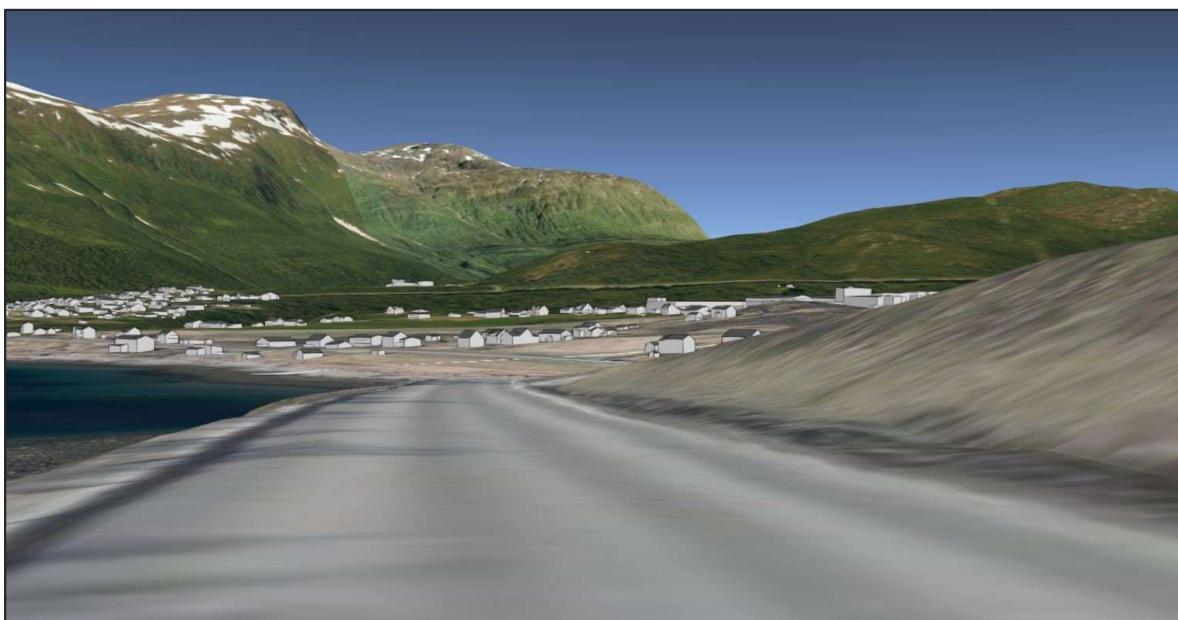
Alt. Dagens situasjon sett i retning Bjerkvik
